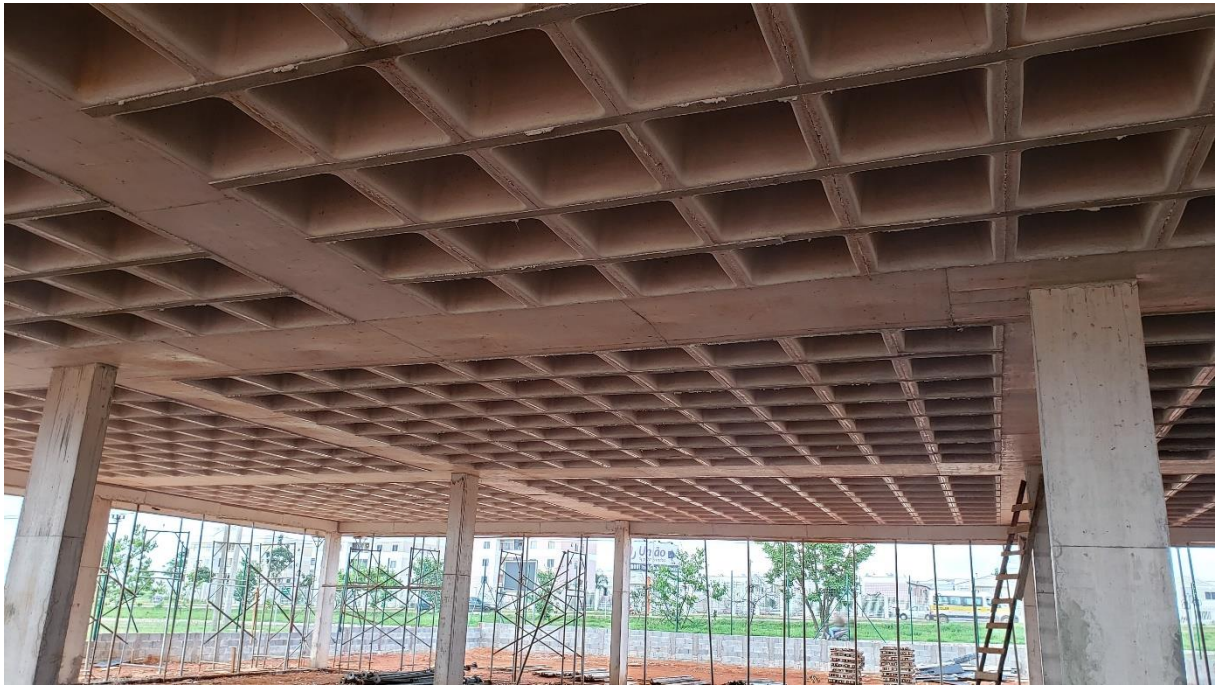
Solução com laje nervurada e vigas faixa executada. (PROEST, 2020).
